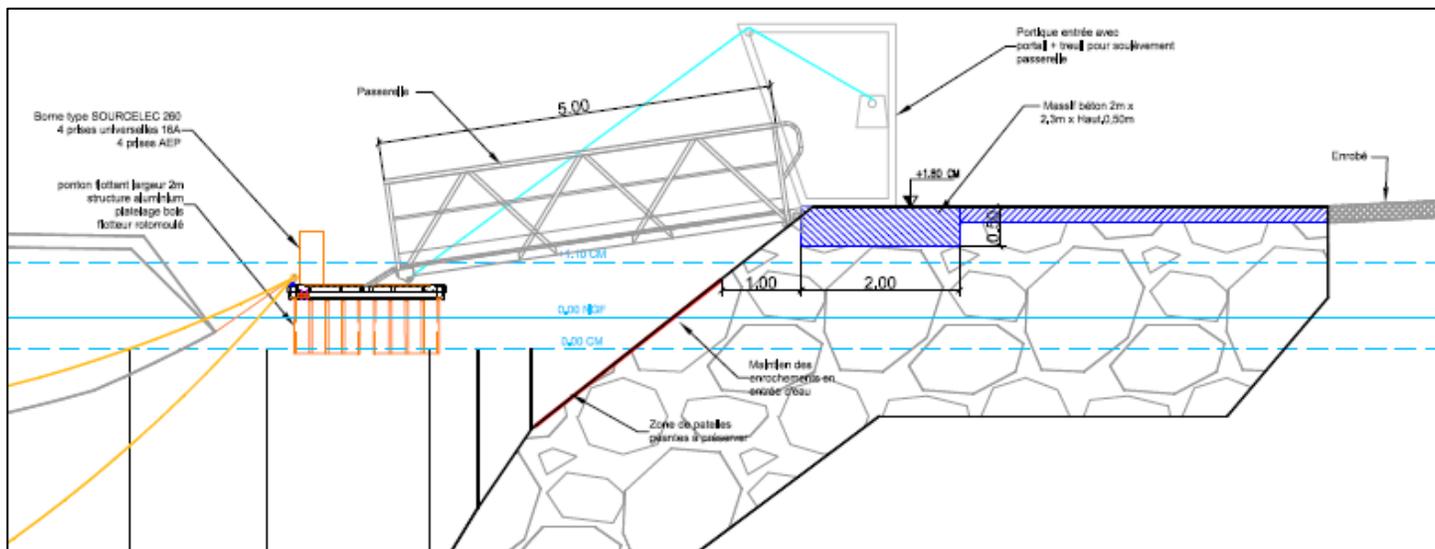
Coupe de principe sur massif béton passerelle Etat existant – ICTP 2020
